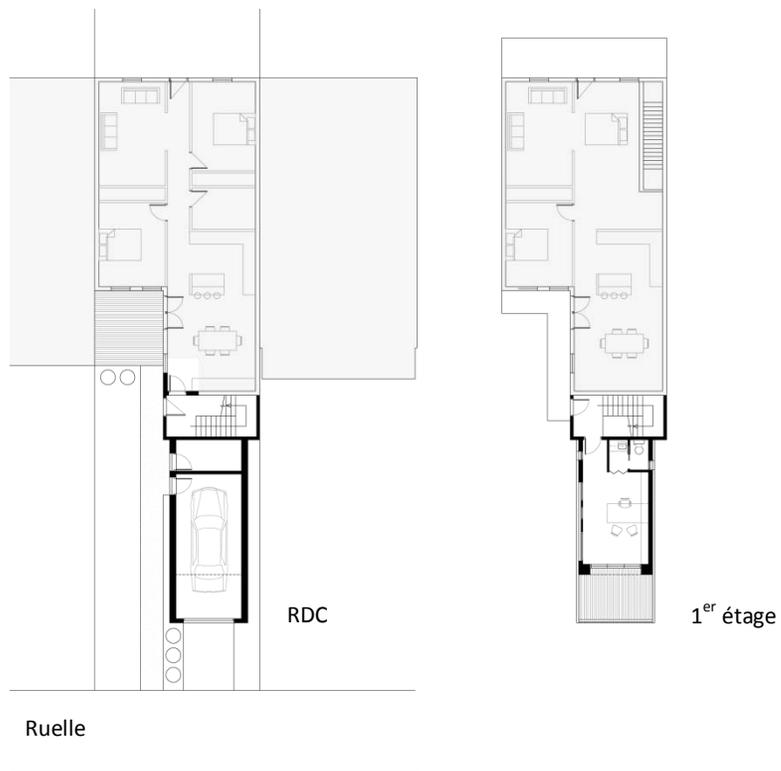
Plans du rez-de-chaussée et de l'étage de l'unité 2.
